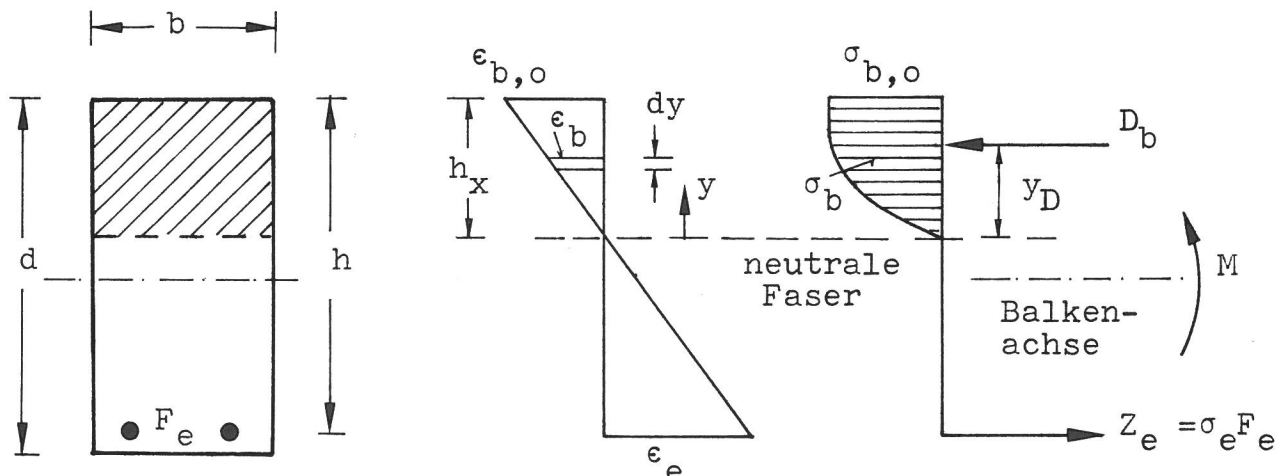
Querschnittsabmessungen, Dehnungs- und Spannungsverteilung in einem gerissenen Stahlbetonquerschnitt
